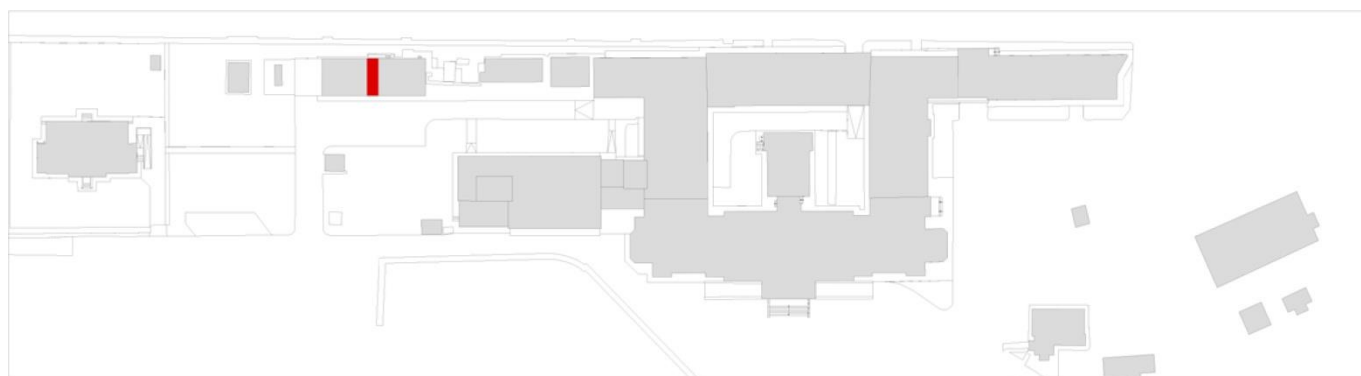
Individuazione del locale centrale aria e vuoto nel fabbricato 9
